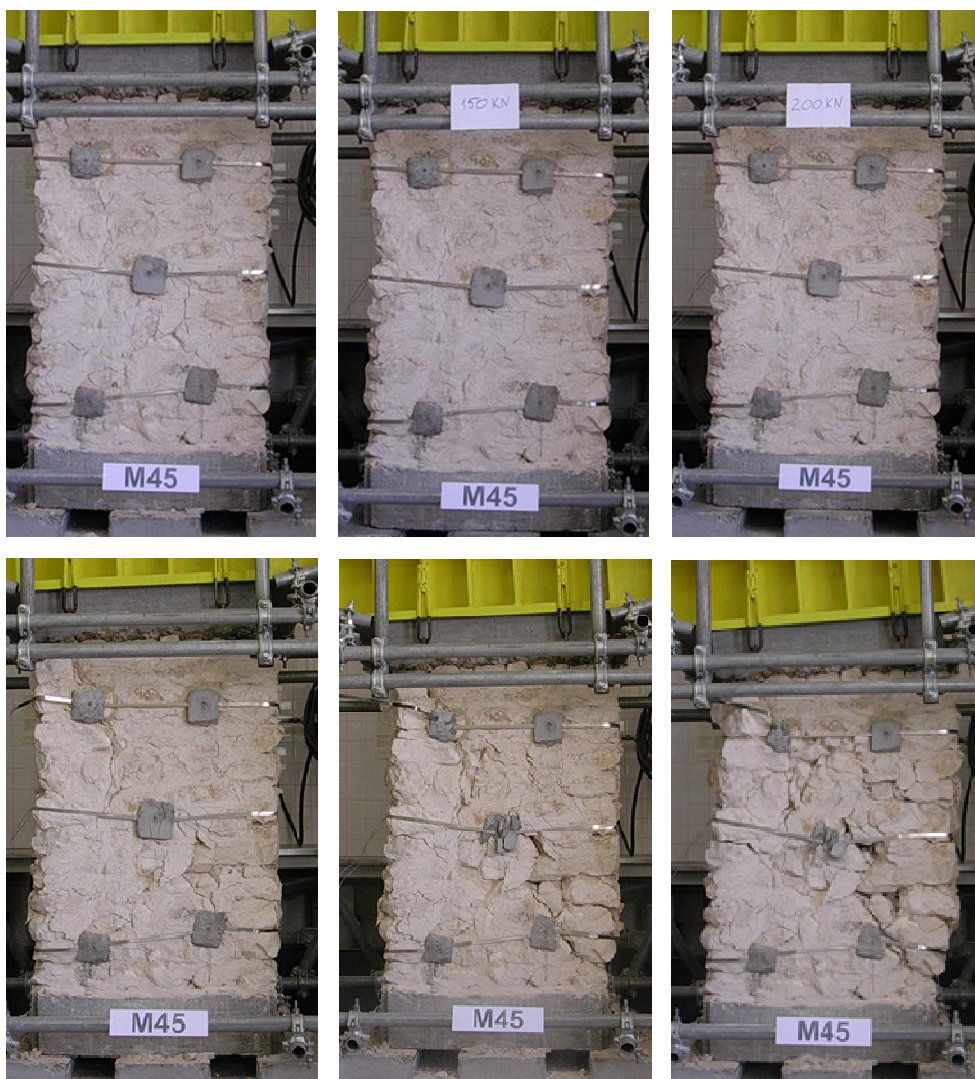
Ensaio de compressão axial sobre o murete M45
